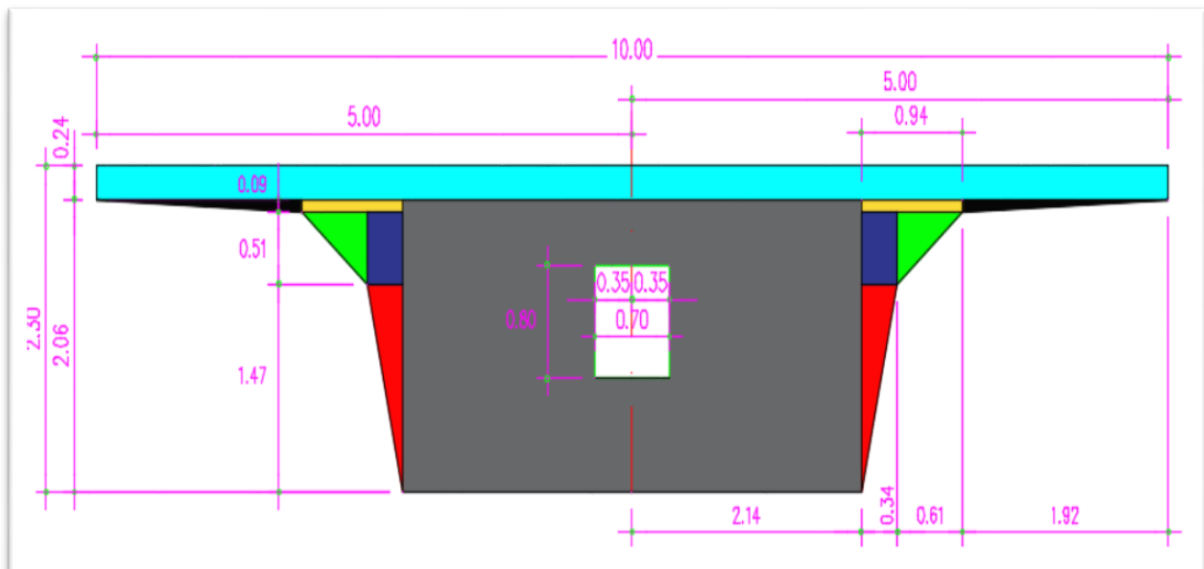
Coupe transversale du voussoir plein sur pile.
